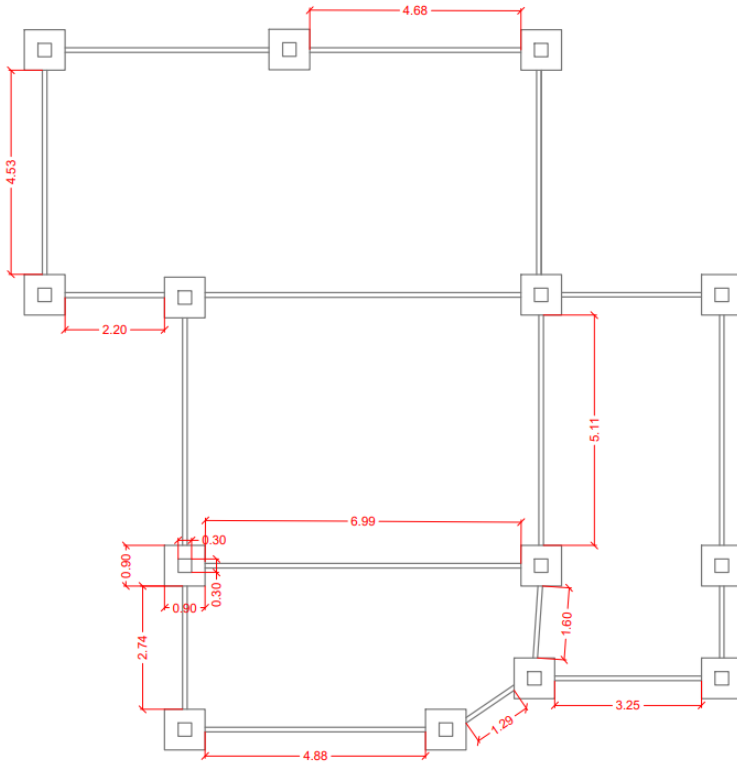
Ubicación y dimensiones de los elementos de cimentación. Fuente propia
